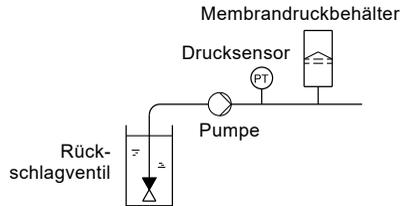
Position des Rückschlagventils und des Drucksensors in Anlagen mit Saugbetrieb
